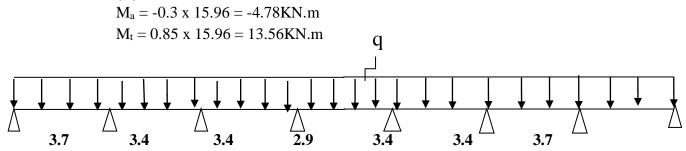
Schéma statique de mur plaque dans le sens Y-Y.
